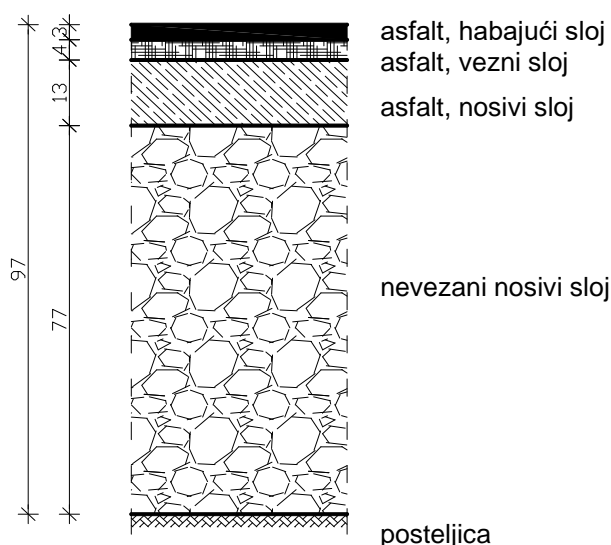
Asfaltna kolnička konstrukcija staze za vožnju E
